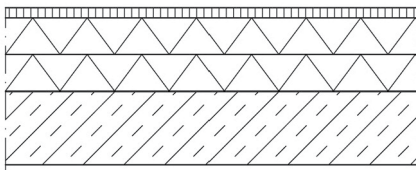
Oberste Geschossdecke aus Stahlbeton (Quelle: C. Uske)
